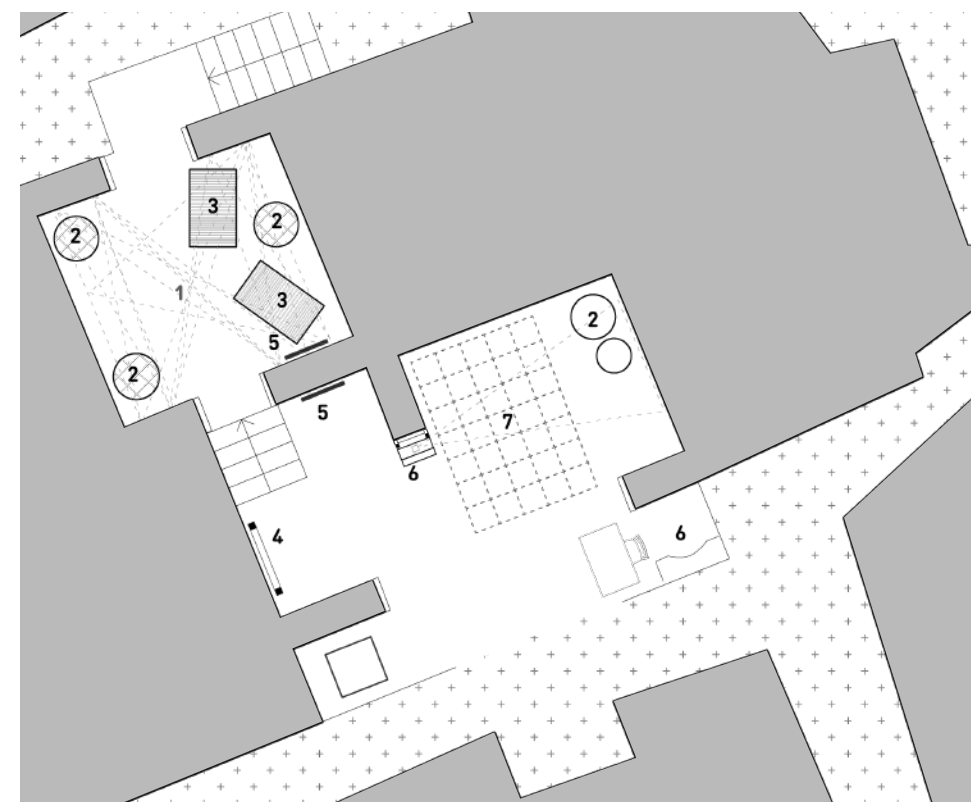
La casa senza tetto. Planimetria e viste con in evidenza gli elementi del progetto:
